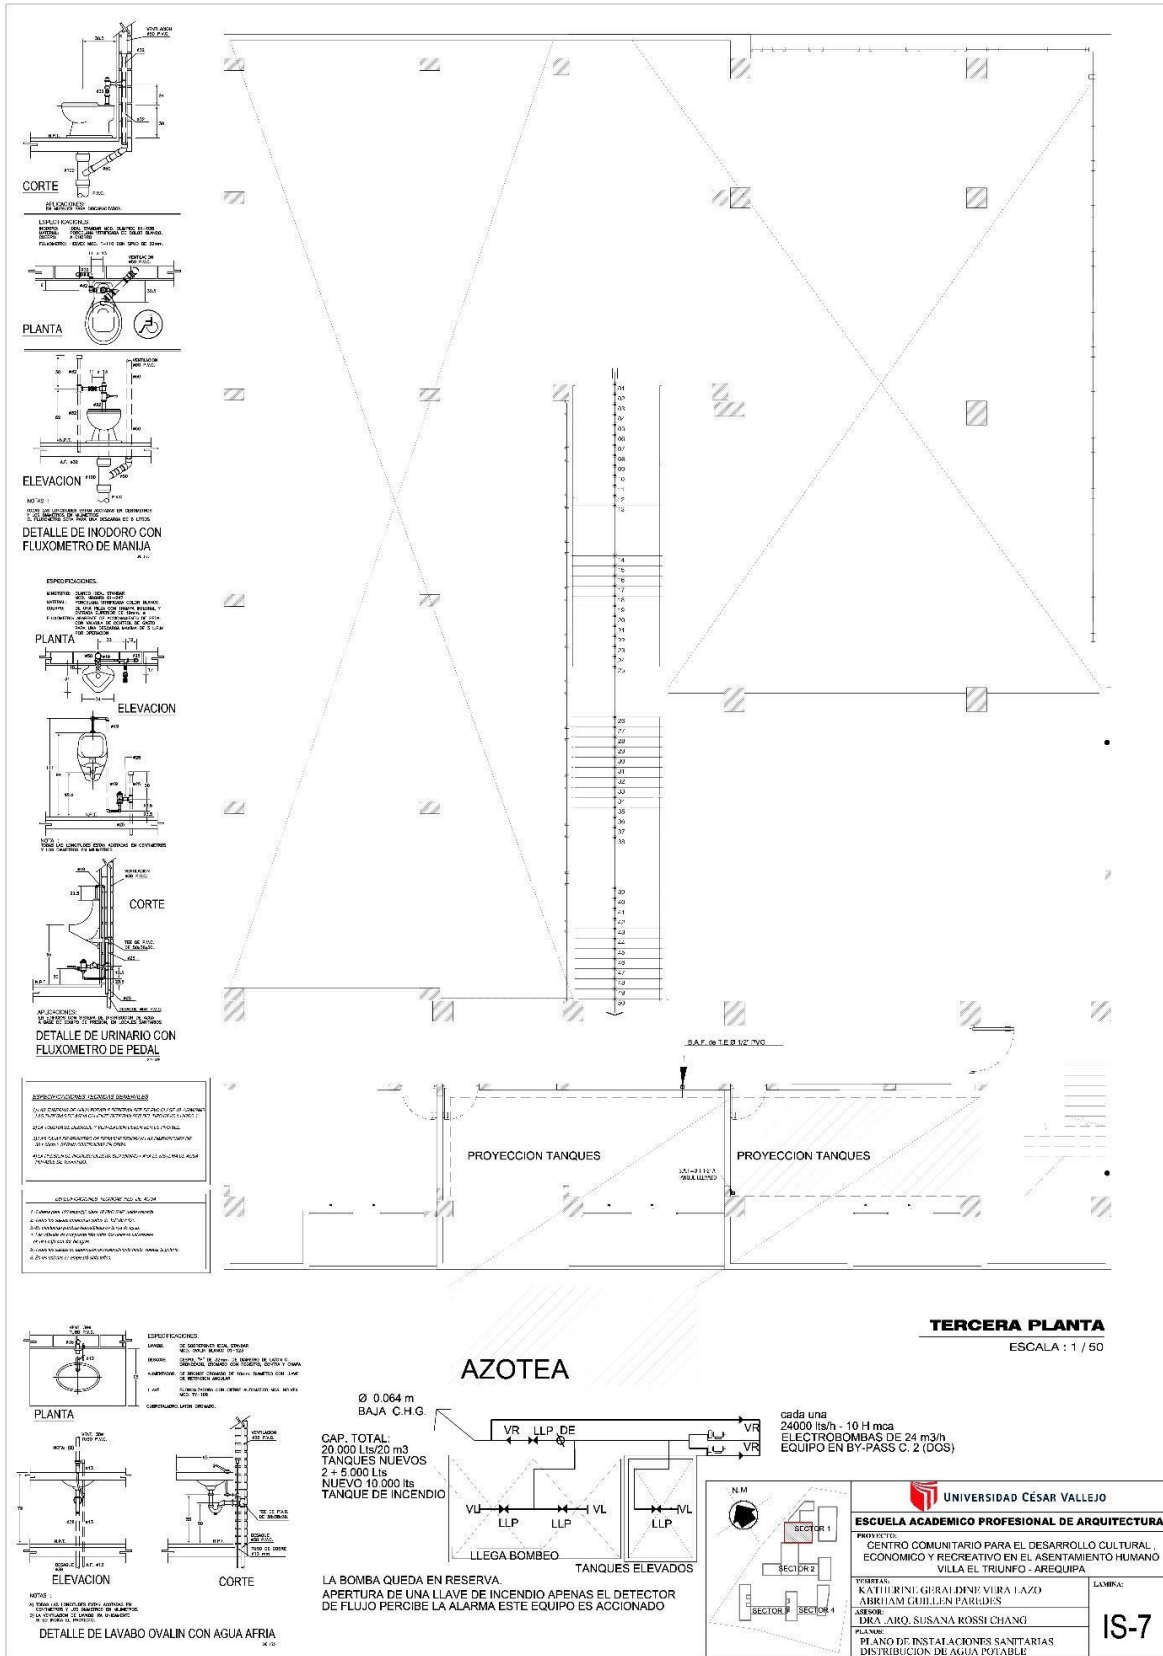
Planos de distribución de redes de agua potable Tercera Planta - Elaboración propia
